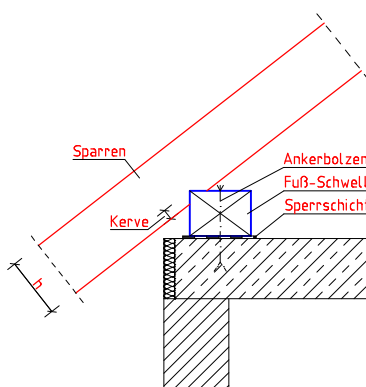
Fußschwelle ohne Dremel mit Bolzen
